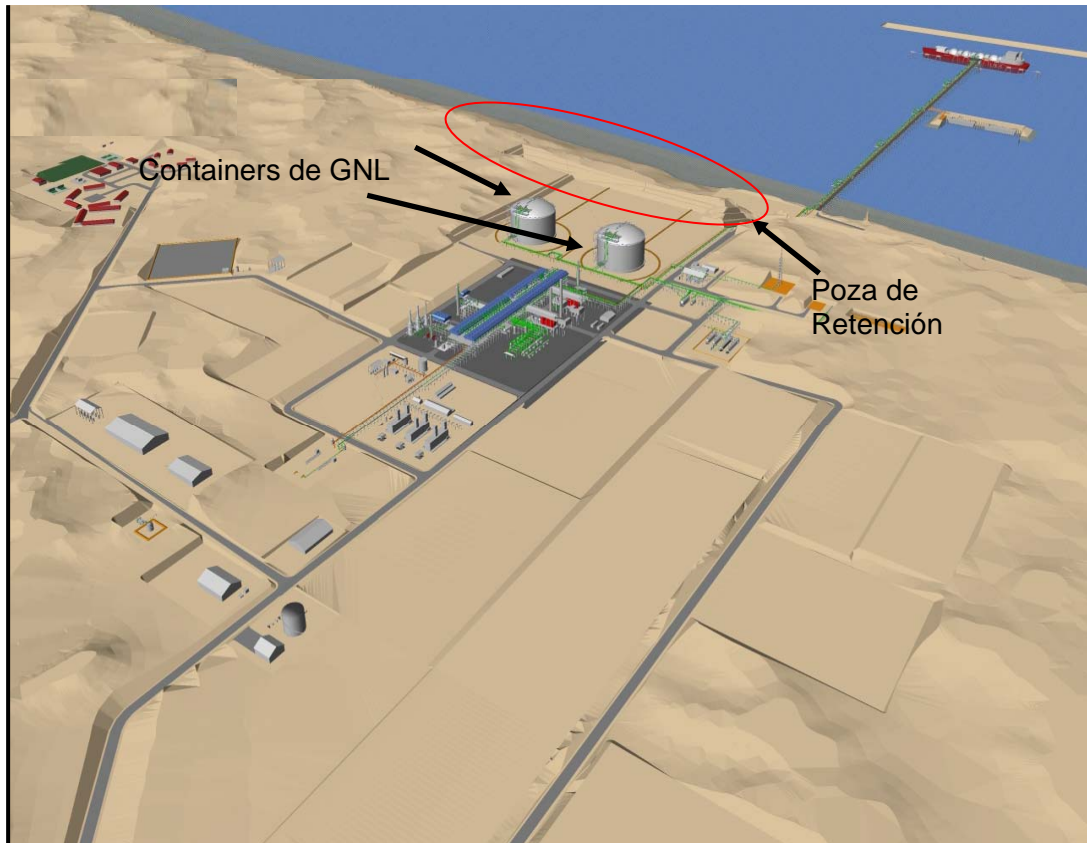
VISTA DE LA FUTURA PLANTA DE LICUEFACCIÓN
